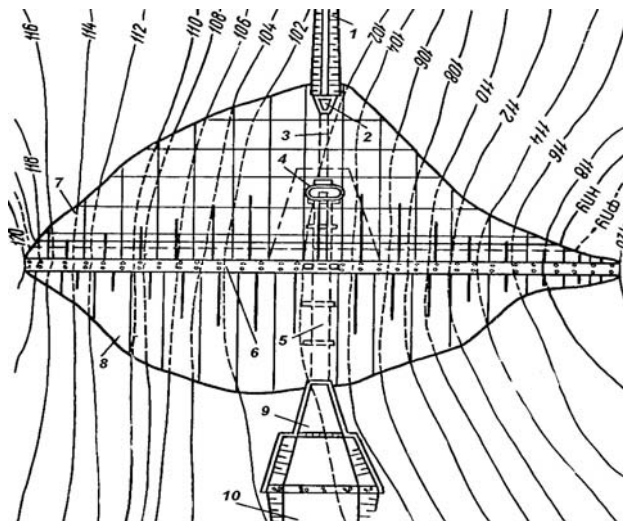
Гидроузел с грунтовой плотиной и закрытым водосбросом-водоспуском:
